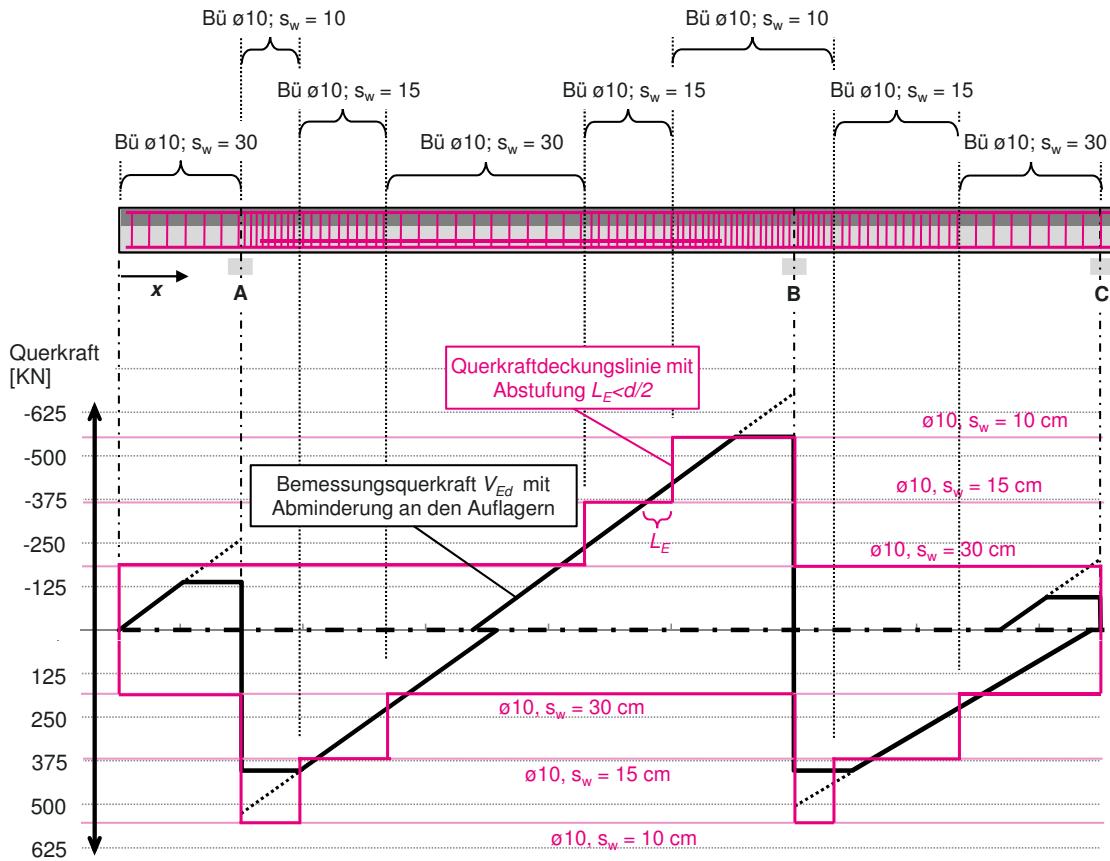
2-Feld-Unterzug mit Kragarm: Ermittlung der Bügelbewehrung mit der Querkraftdeckungslinie
